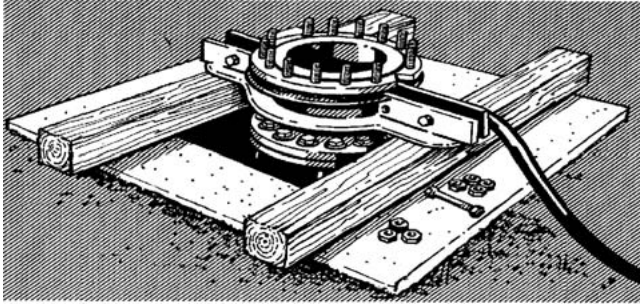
Maintien en place de la colonne montante pendant l'installation
